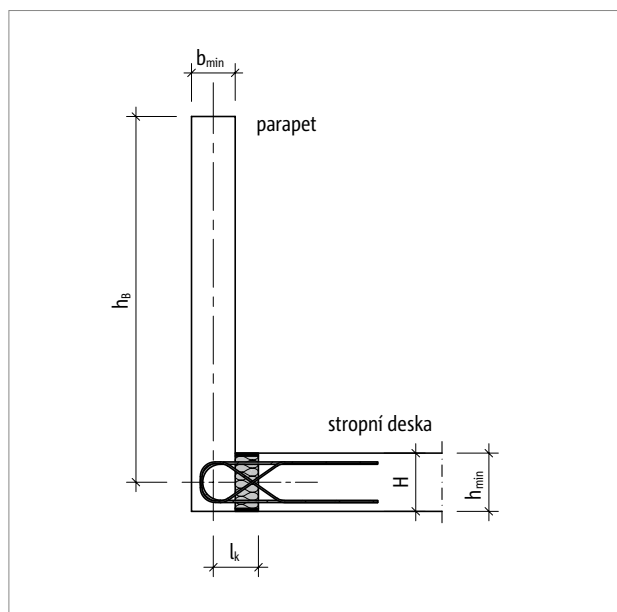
Schöck Isokorb® T typ AP: Znaménková konvence pro dimenzování parapetů uložených na stropní desce
